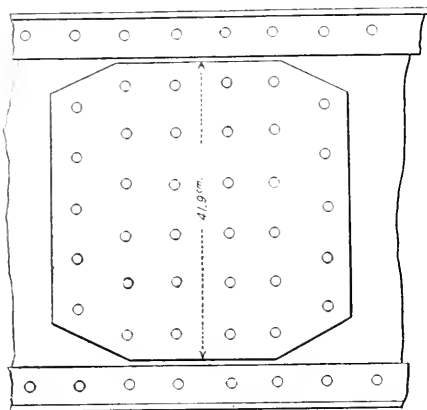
DETALLE DE LA PLANCHA DE UNIÓN
